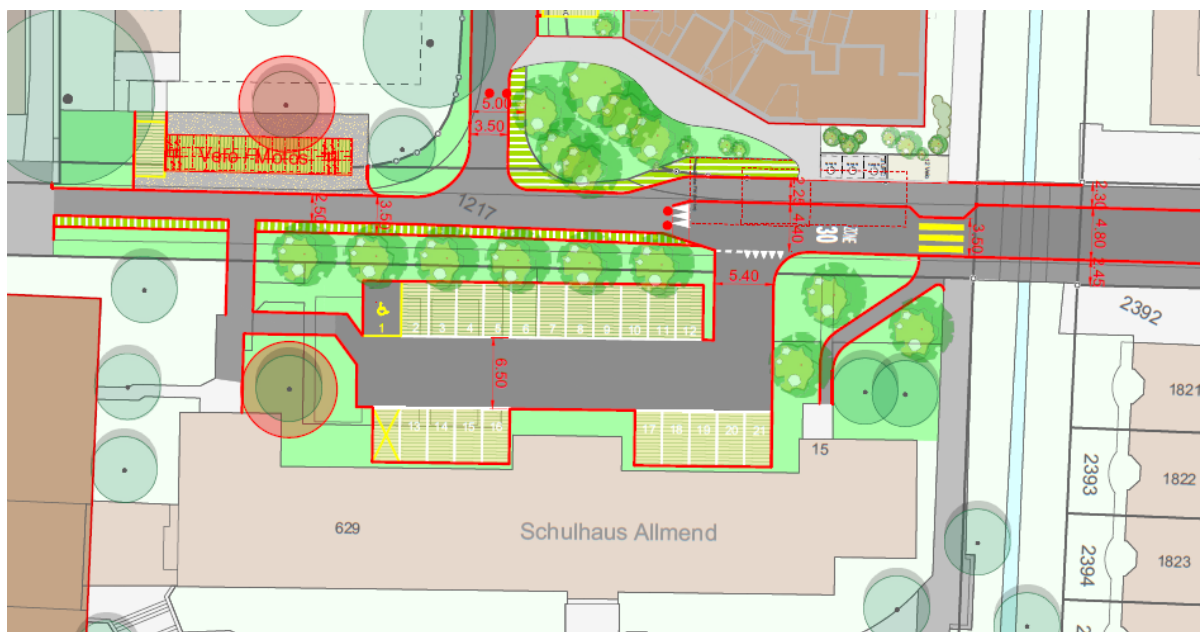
Planausschnitt BGK Schulhausstrasse
